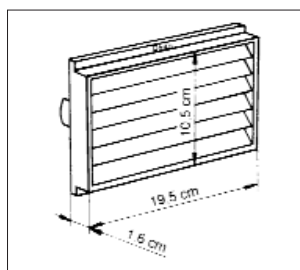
Zásuvná vnější mřížka (d=145 mm)
